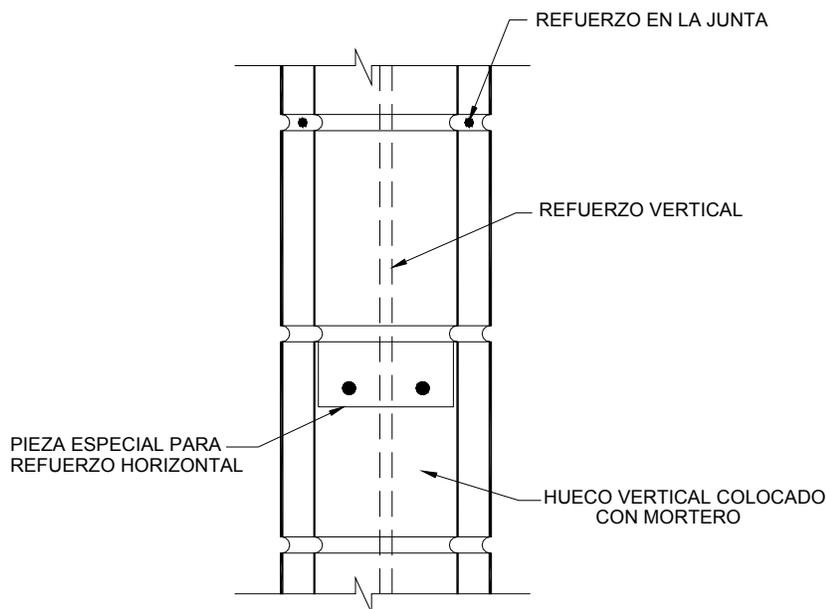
REFUERZOS VERTICALES Y HORIZONTALES
